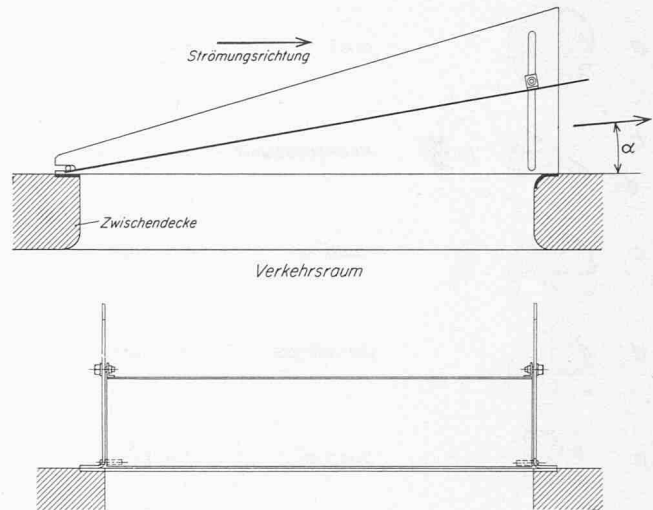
Einstellbare Abluftklappe für den Einbau in die Tunnel-zwischendecke (Konstruktion Luwa AG)
